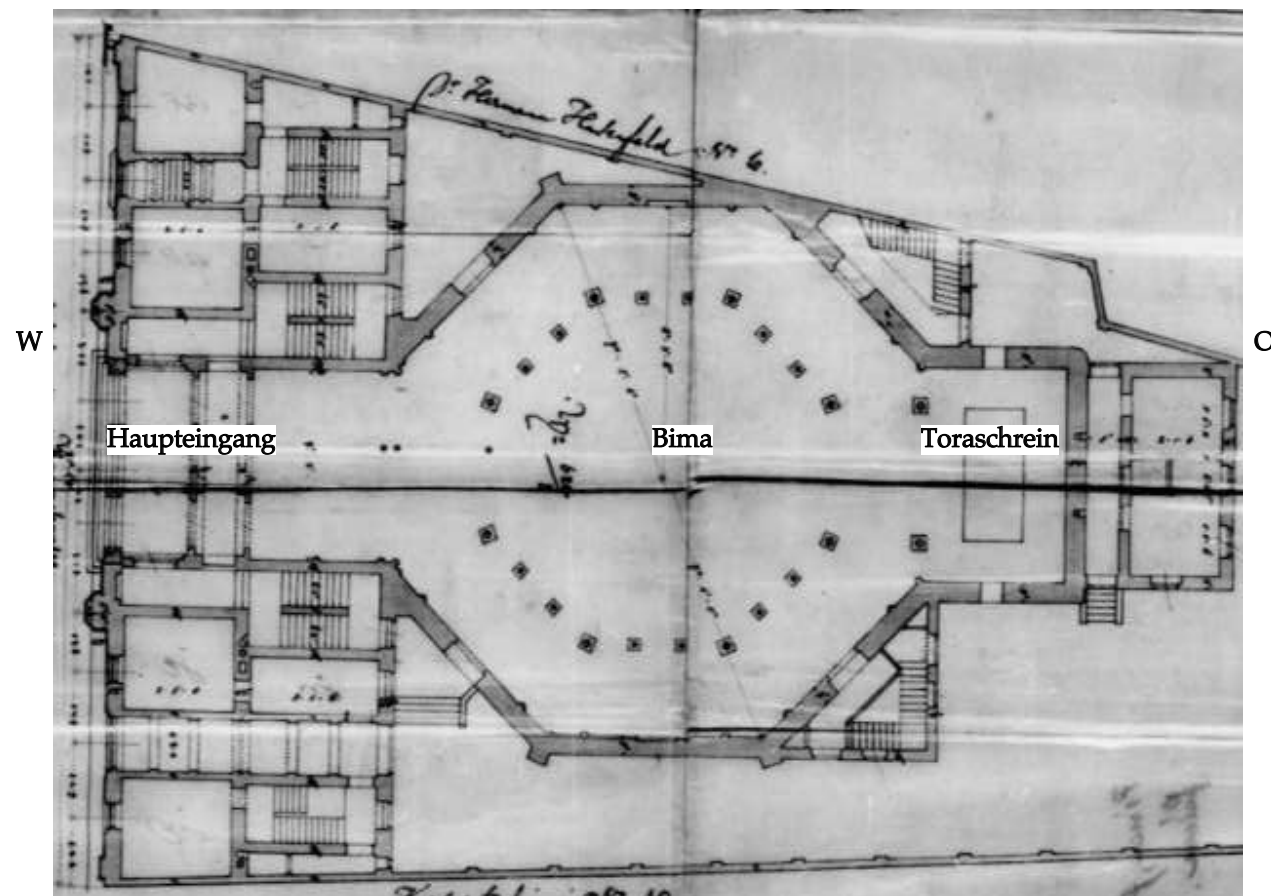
Grundriss EG Einreichplan Rumbach Synagoge
